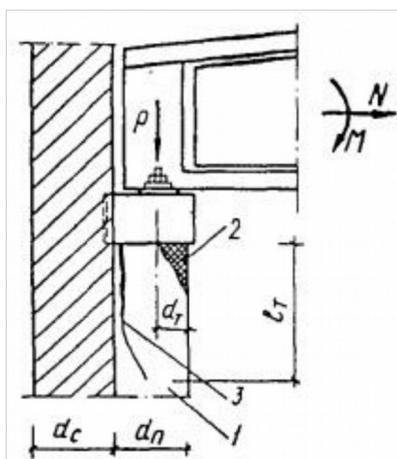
Характерные случаи повреждения опорных участков пилястр каменных стен при опирании на них ферм и балок [6]:
